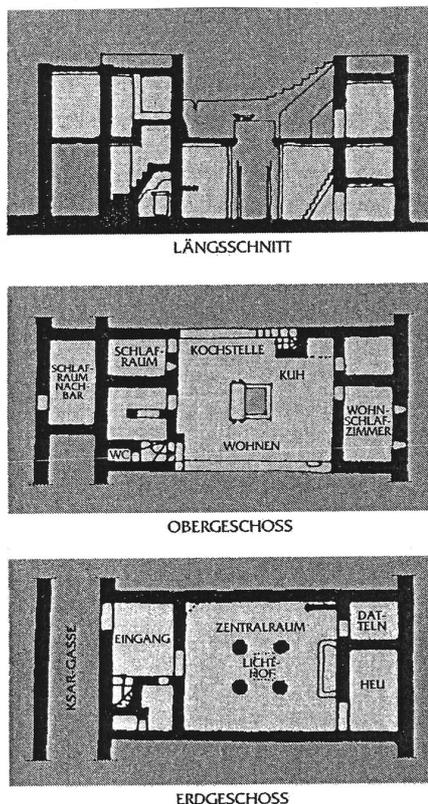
q̣sar*-Haus: Längsschnitt, Grundrisse des Erdgeschoßes und des Obergeschoßes
